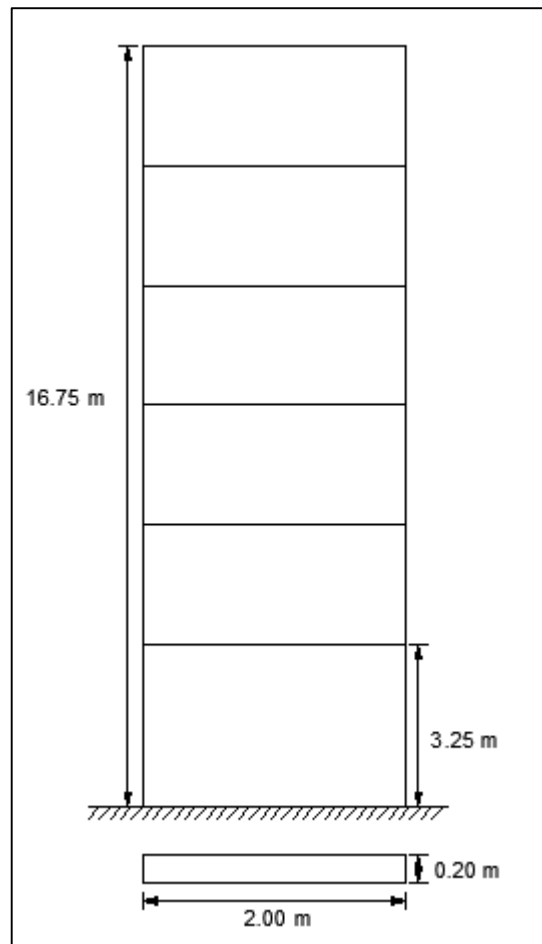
Datos generales en elevación y planta para diseño de placa.
